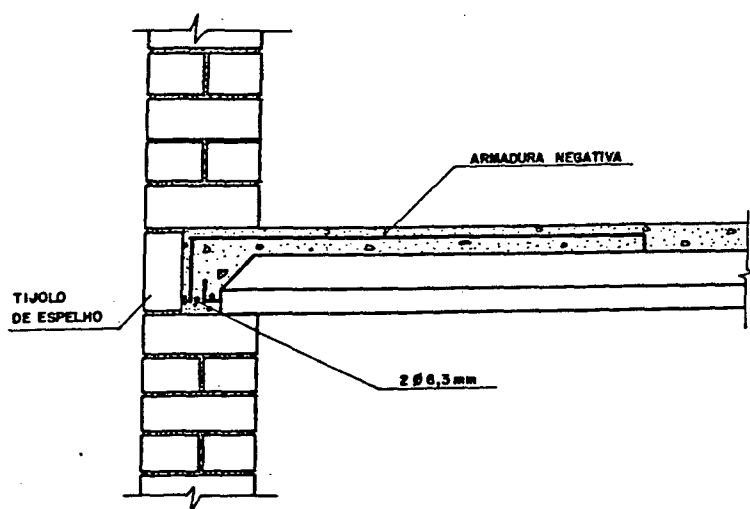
LAJE APOIADA EM ALVENARIA
